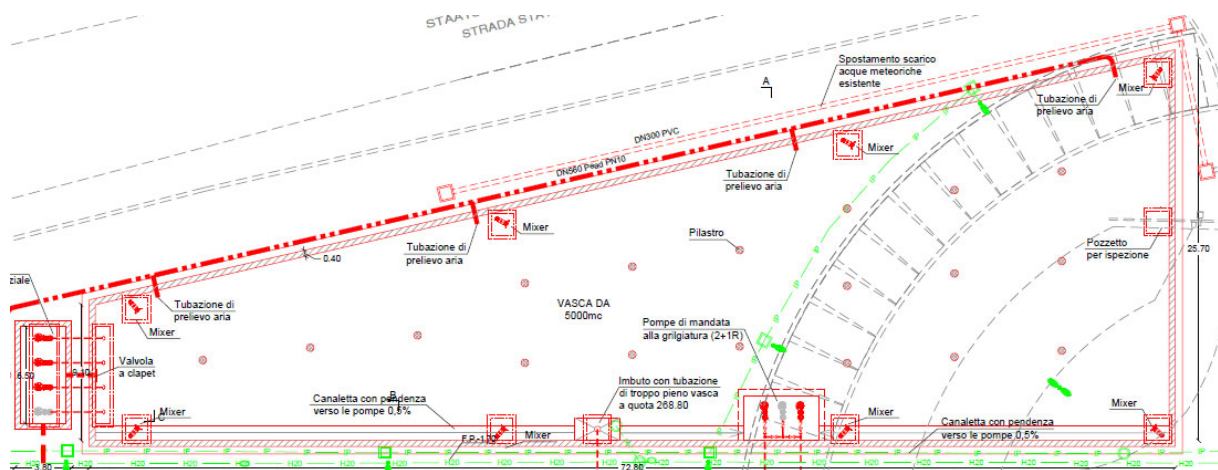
Grundriss Ausgleichbecken / planimetria vasca di omogenizzazione
